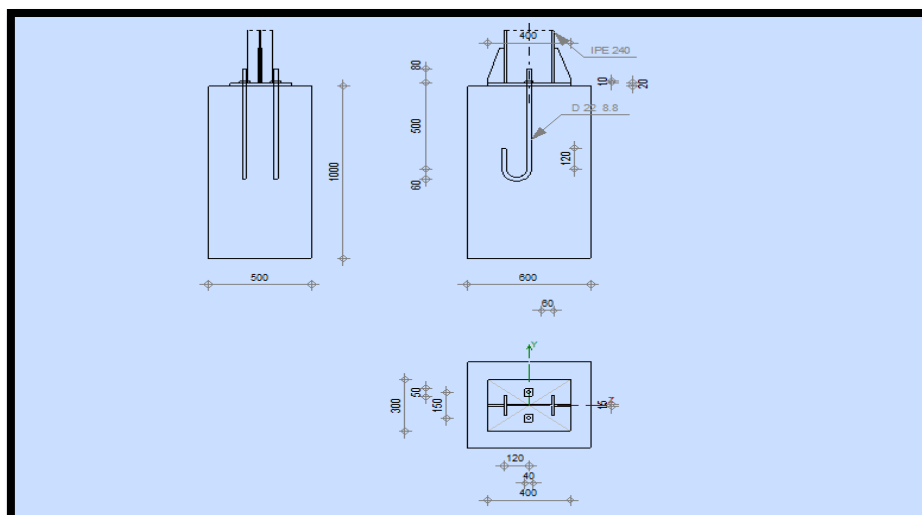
détails sur l'assemblage pied de poteau articulé.
